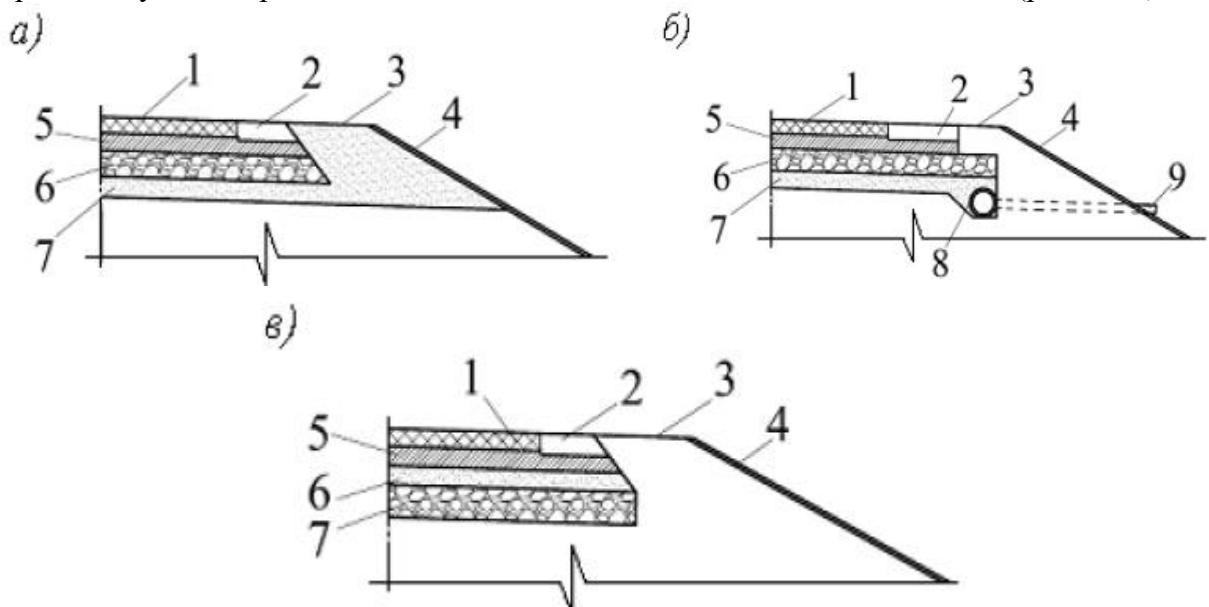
Конструкция дорожной одежды с теплоизолирующими слоями:
